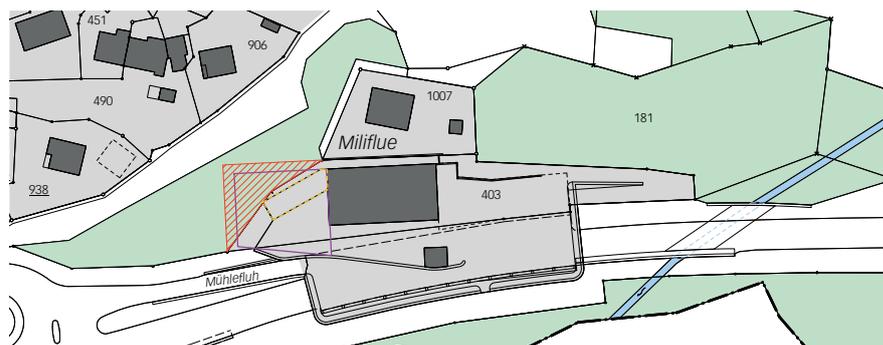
Detailplan Rodung; rot schraffiert: Rodungsfläche; gelb: Abbruch bestehendes Gebäude; violett: geplantes Gebäude
